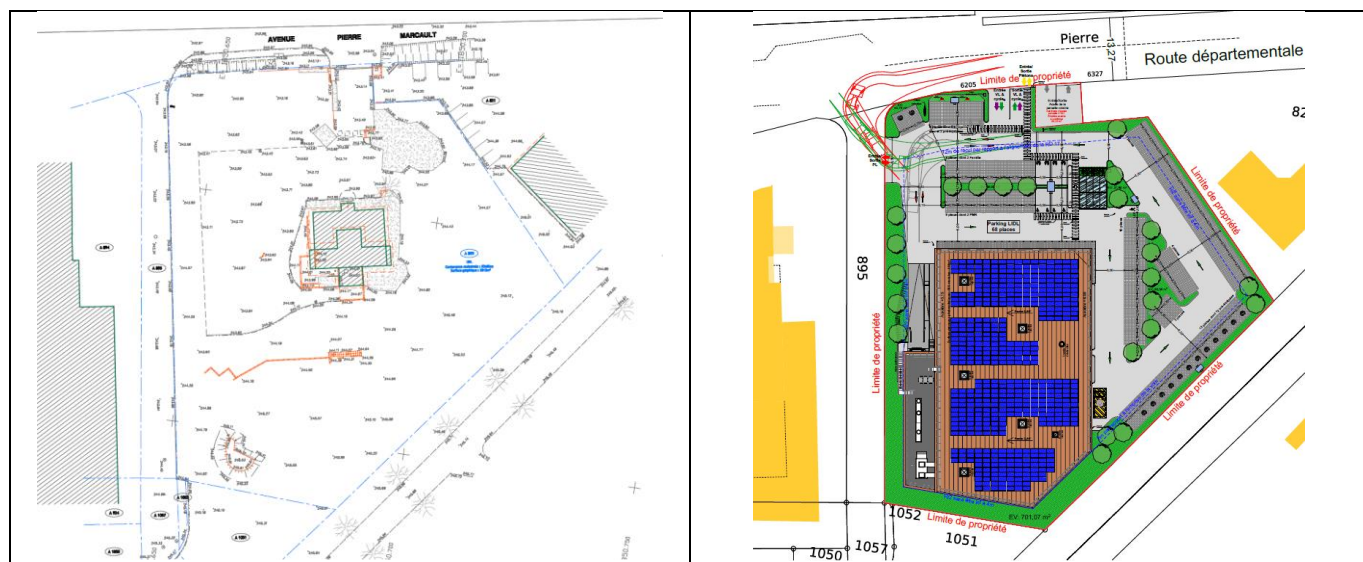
Extrait du plan topo de l'existant (gauche) et du plan masse du projet (droite) (sans échelle)
